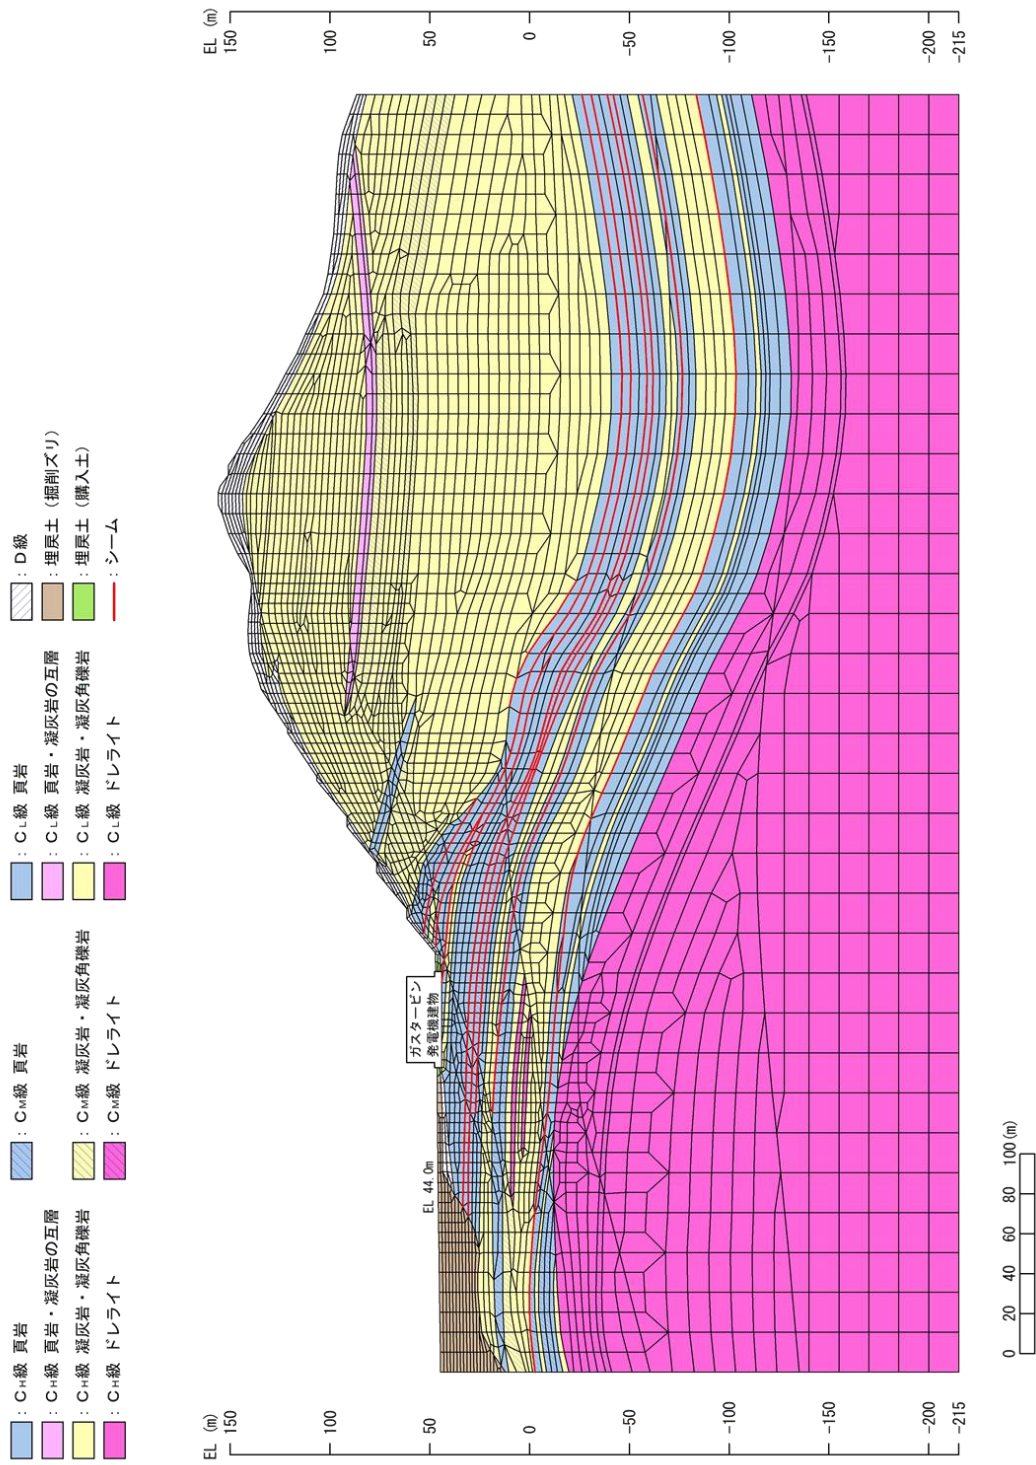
解析モデル図 (12-12' 断面)
